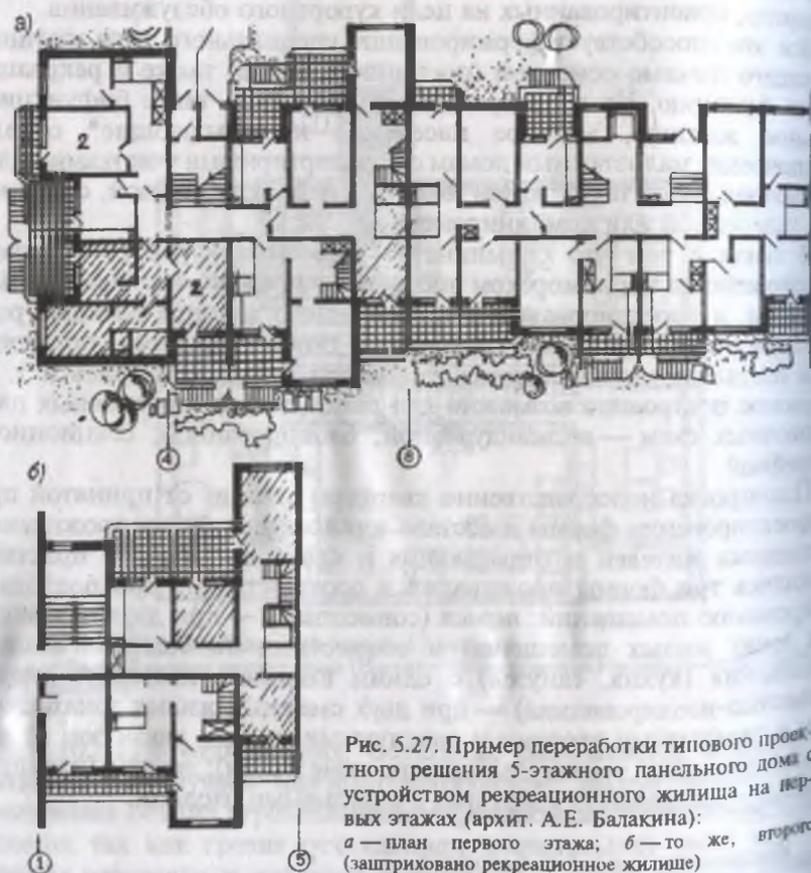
Пример переработки типового проектного решения 5-этажного панельного дома с устройством рекреационного жилища на первых этажах (архит. А.Е. Балакина): а — план первого этажа; б — то же, второго (заштриховано рекреационное жилище)
